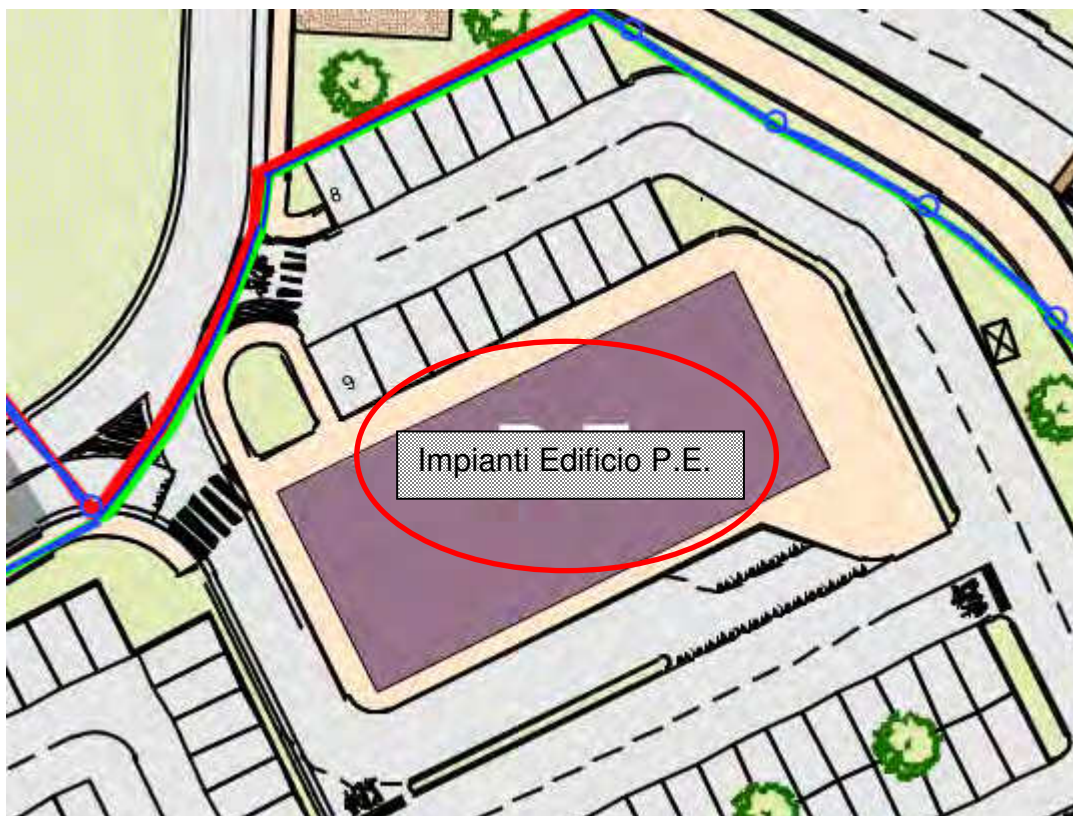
Localizzazione degli impianti Edificio P.E.
